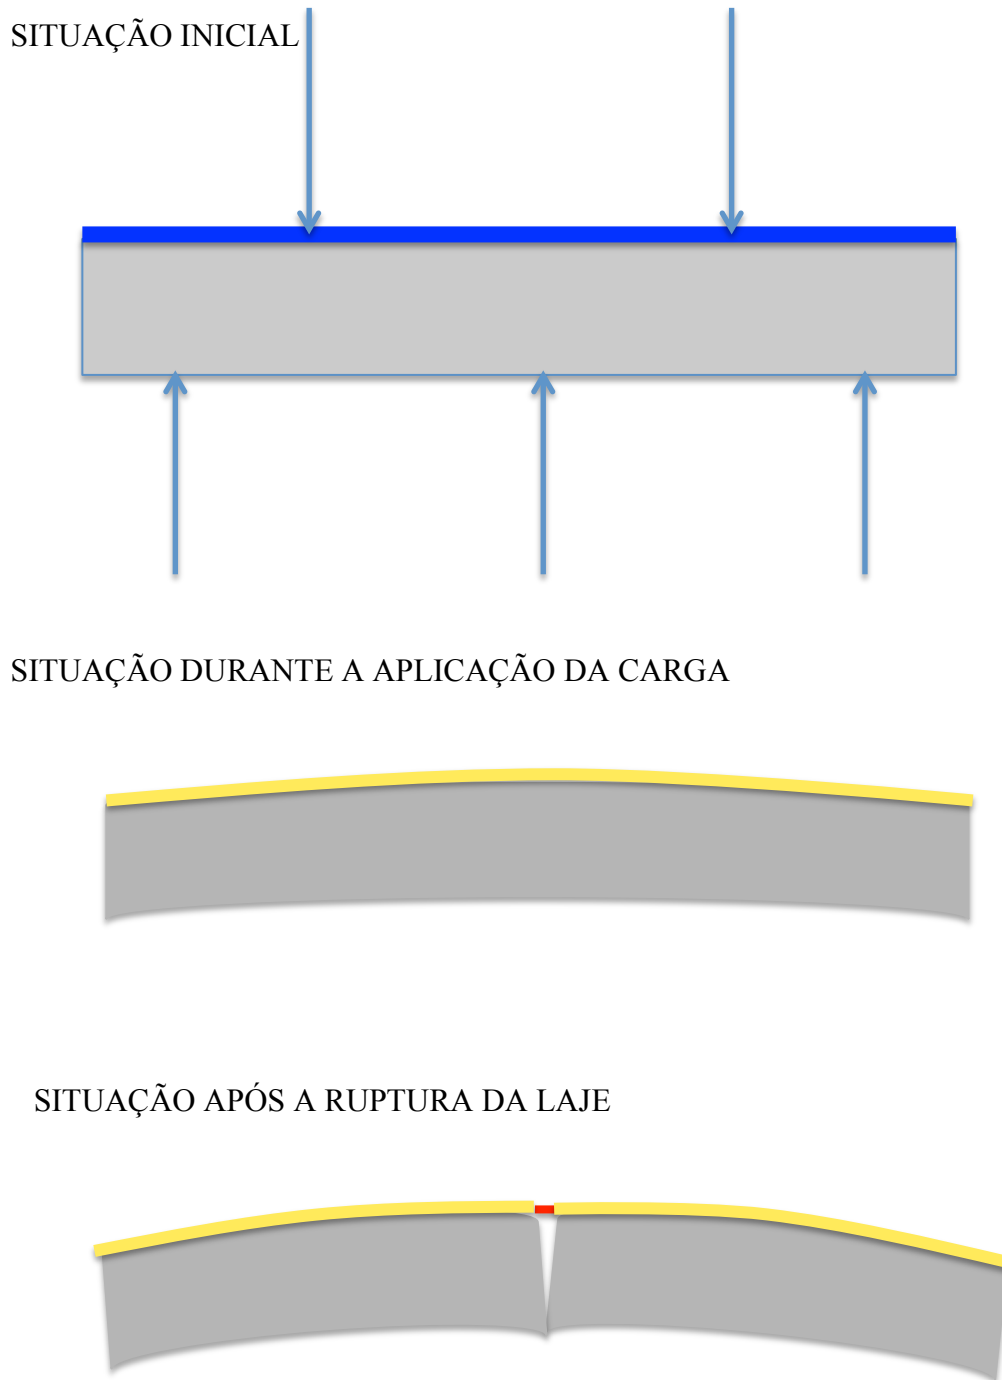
Croqui da dinâmica do ensaio de flexão das lajes de concreto armado
